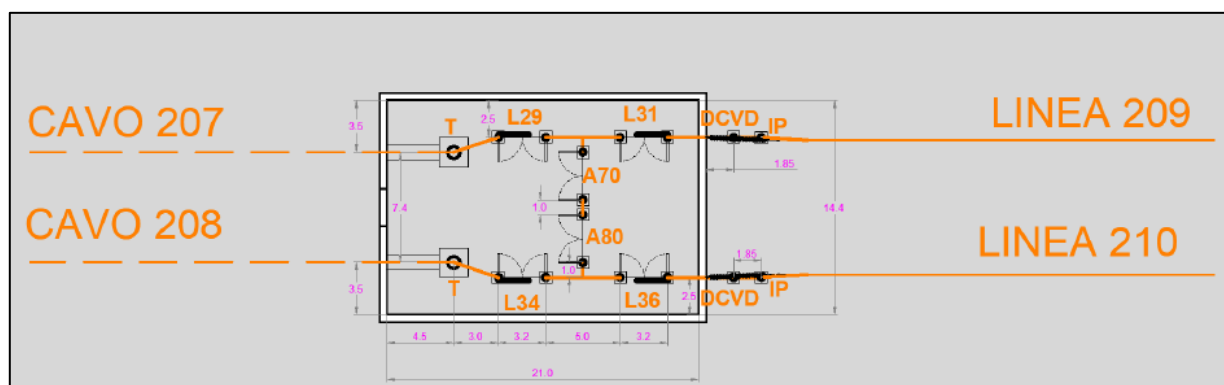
Schema collegamenti punto di transizione Salivoli stato attuale
